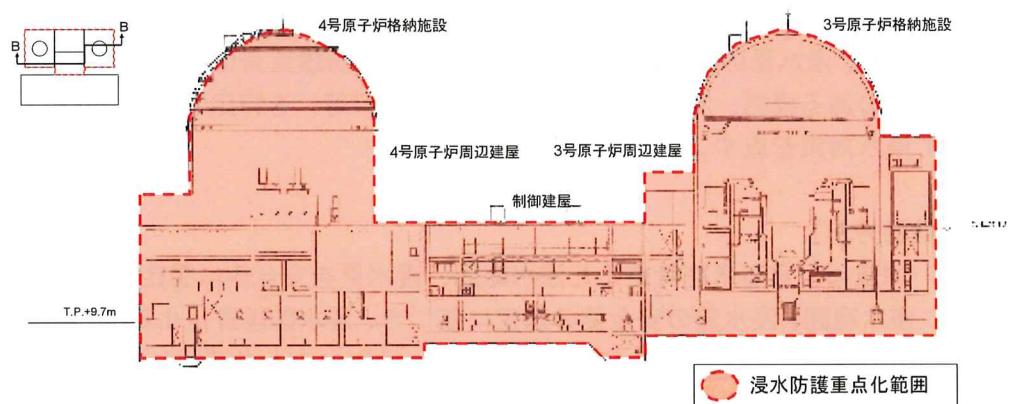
大飯 3, 4 号炉 建屋断面図及び浸水防護重点化範囲 (B-B 断面)
